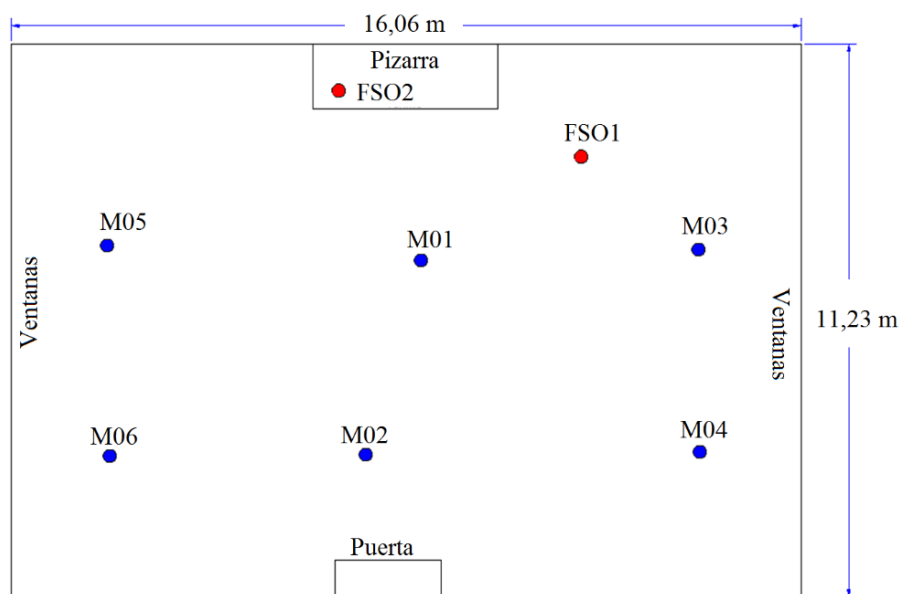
Vista en planta y coordenadas de medición, Aula 405.
